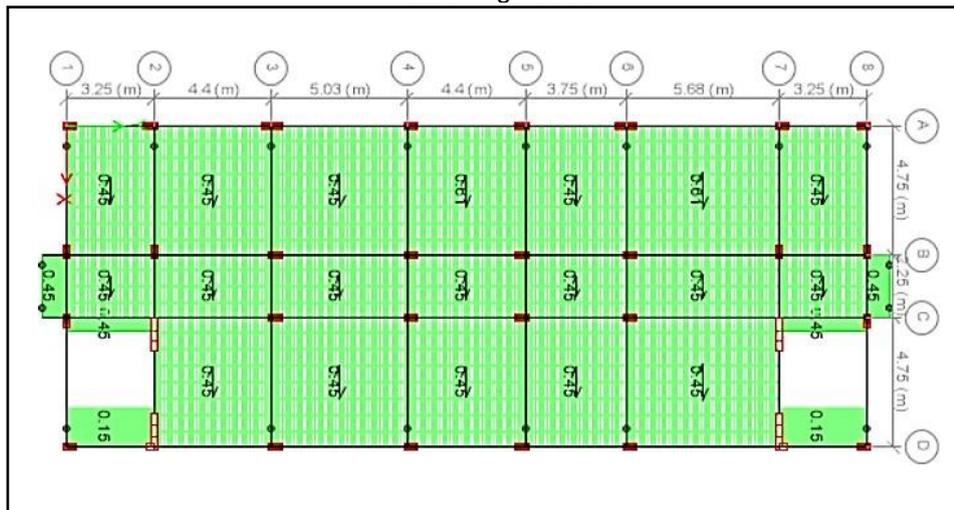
Vista en Elevación de Distribución de Cargas Muertas en Vigas
